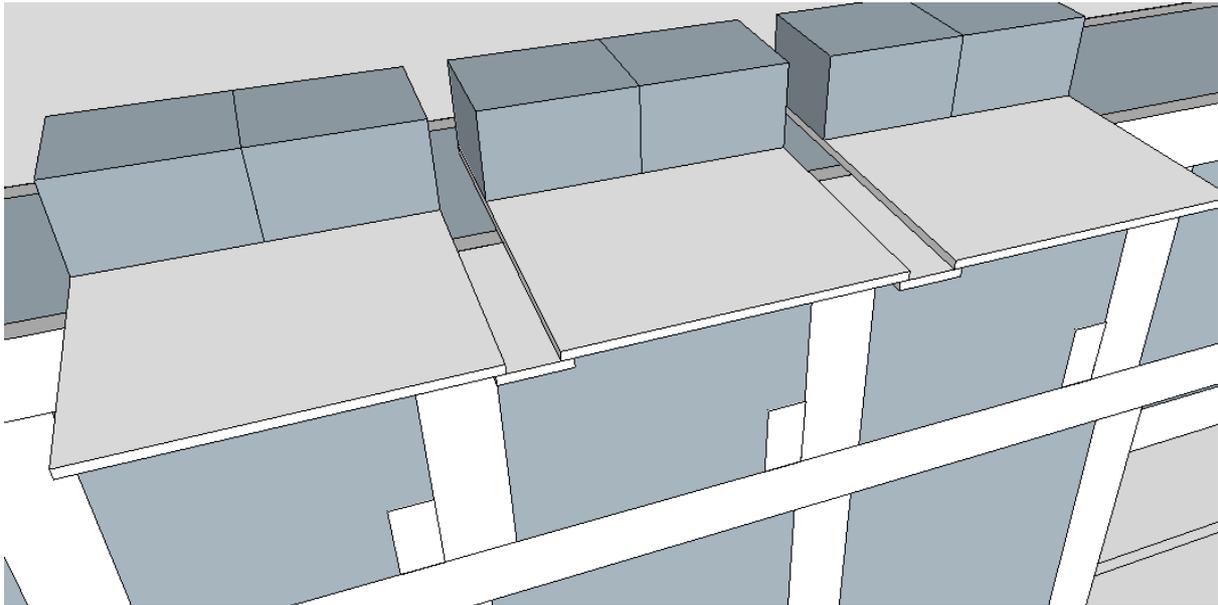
Sur le côté le plus bas, des lamelles d'ardoise placées par-dessous faisant office de gouttières.
